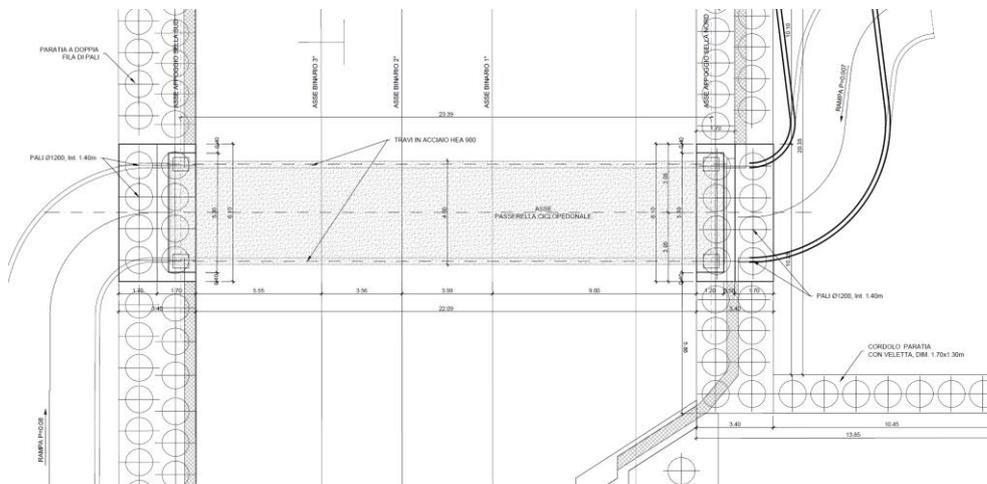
Passerella pedonale nella stazione di Ellera: pianta struttura portante
